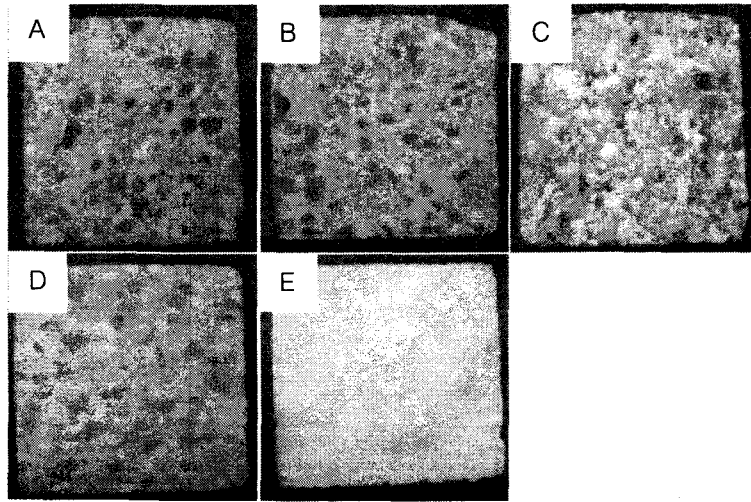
Spalling Test 후의 각 시험품의 외관상태
